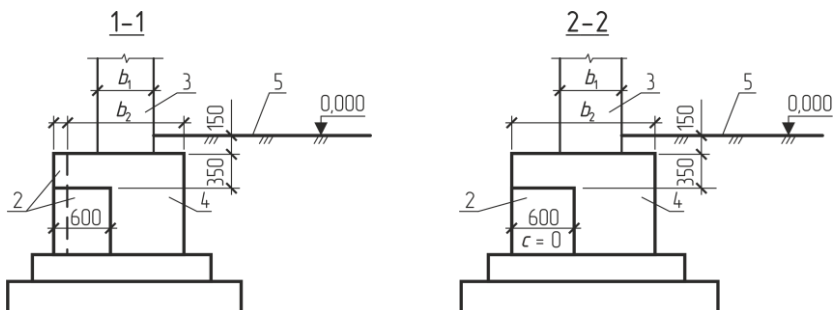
Опираие фундаментных балок на типовые монолитные фундаменты при шаге колонн 6 м:
